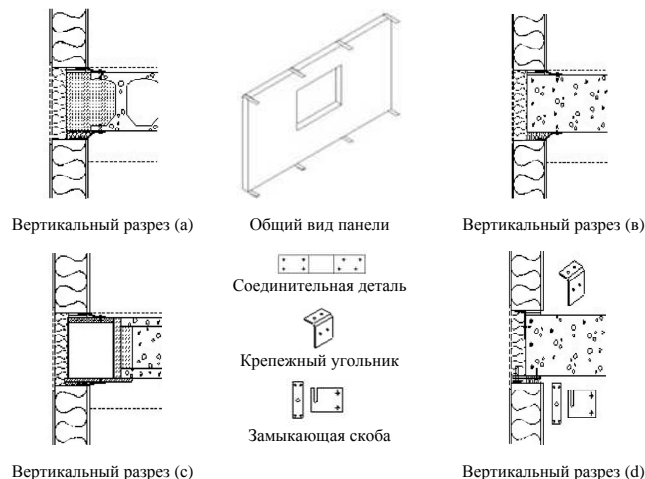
Общая схема крепления панелей к несущему железобетон- ному каркасу
